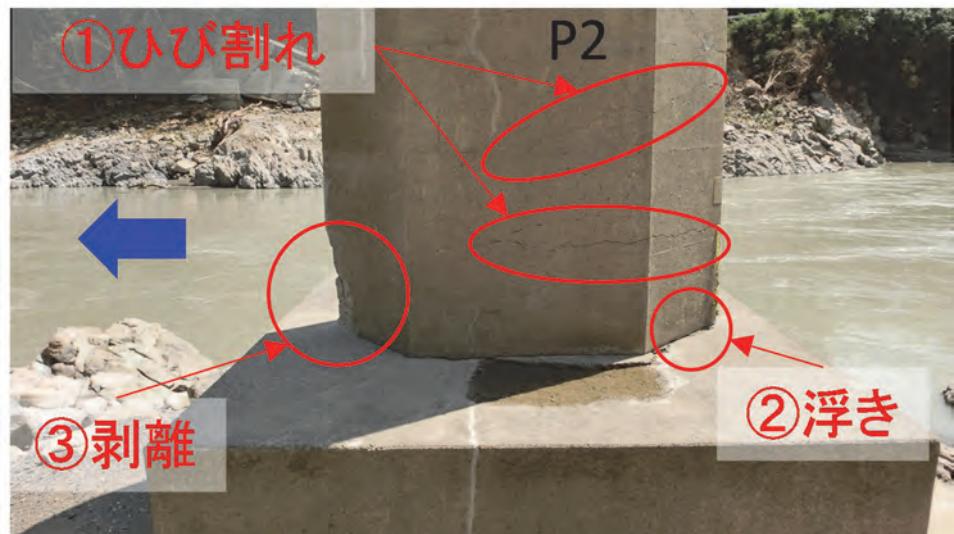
P2 橋脚の変状状況 (A2 側から撮影)
